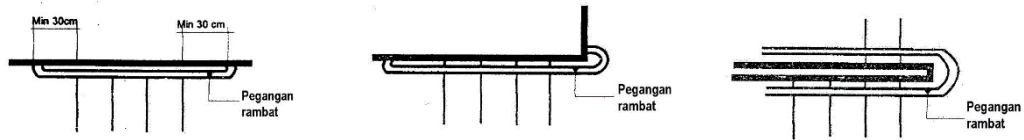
3 Detail Pijakan & Handrail Tangga
